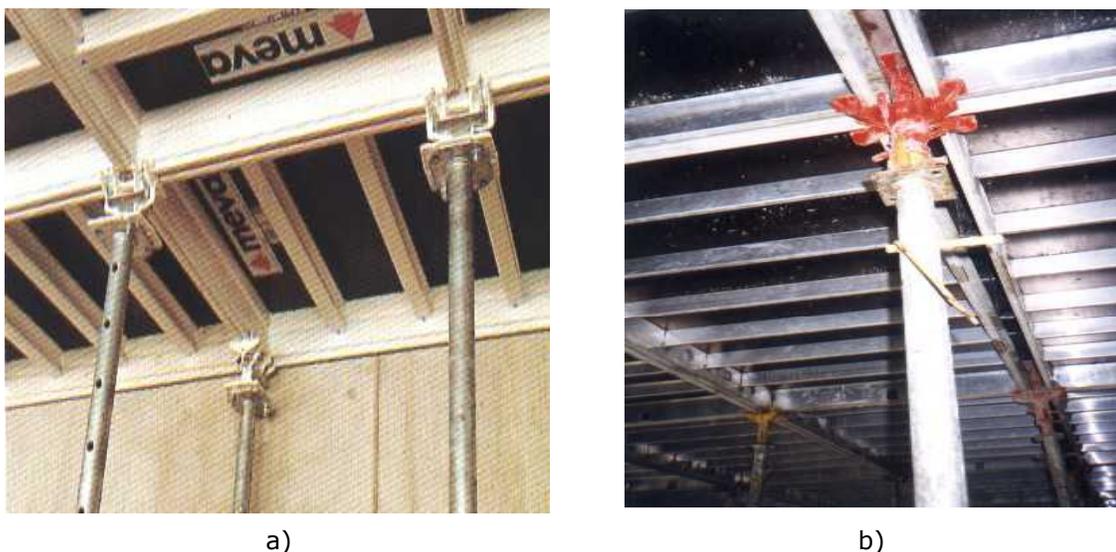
Escoramento do sistema modular: a) painéis apoiados em escoras com cabeças fixas; b) painéis apoiados em escoras com cabeças descendentes.
